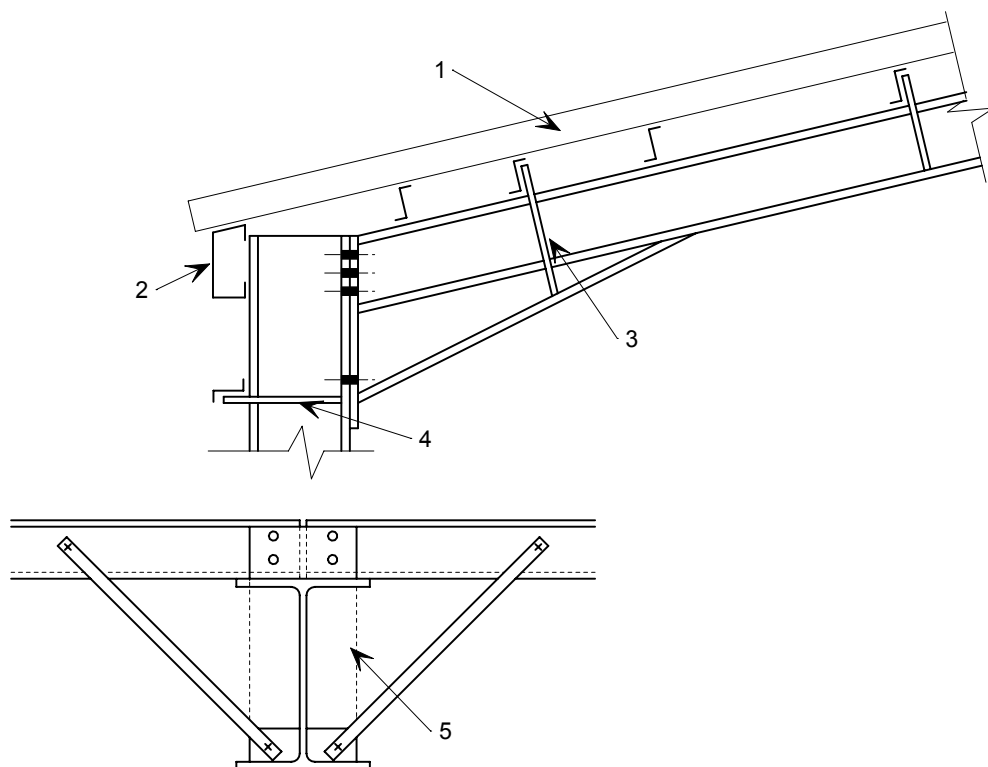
Detail s podélnou vzpěrou/výztuhou, která nevyztužuje dolní část náběhu
